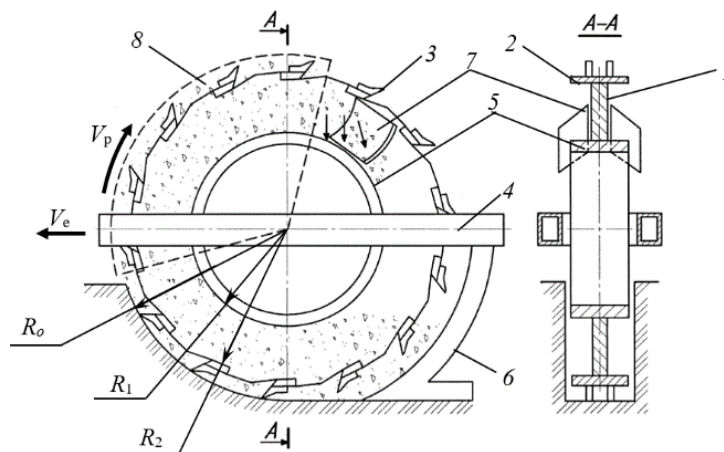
Роторний безківшевий робочий орган: 1 – центральний диск; 2 – траверса; 3 – ріжучий елемент; 4 – рама; 5 – обичайка; 6 – зачисний башмак; 7 – ґрунтознімач; 8 – кожух
